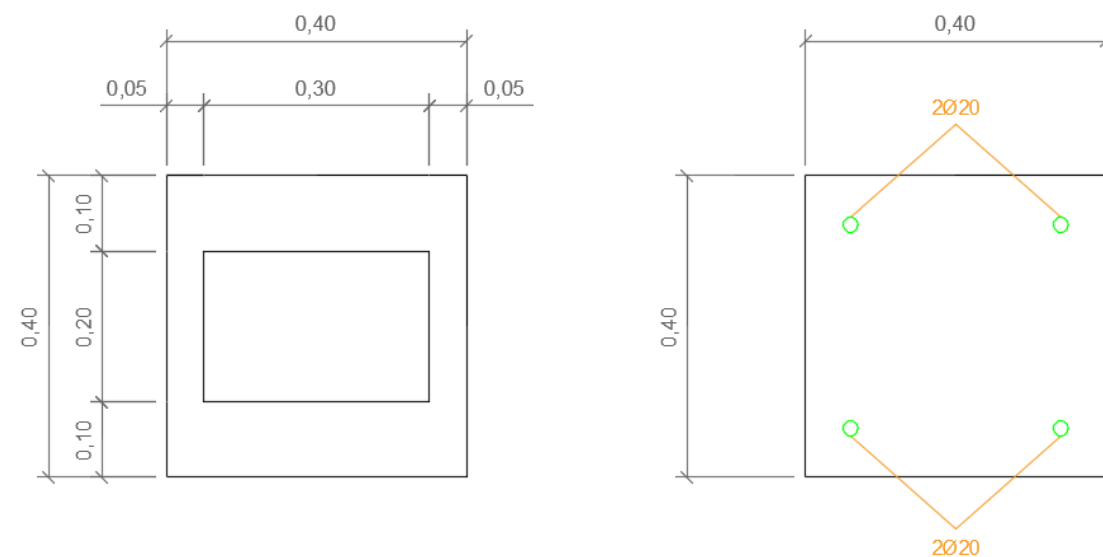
Sección tipo de la viga transversal en tramo aligerado (izquierda) y en tramo macizado (derecha)
